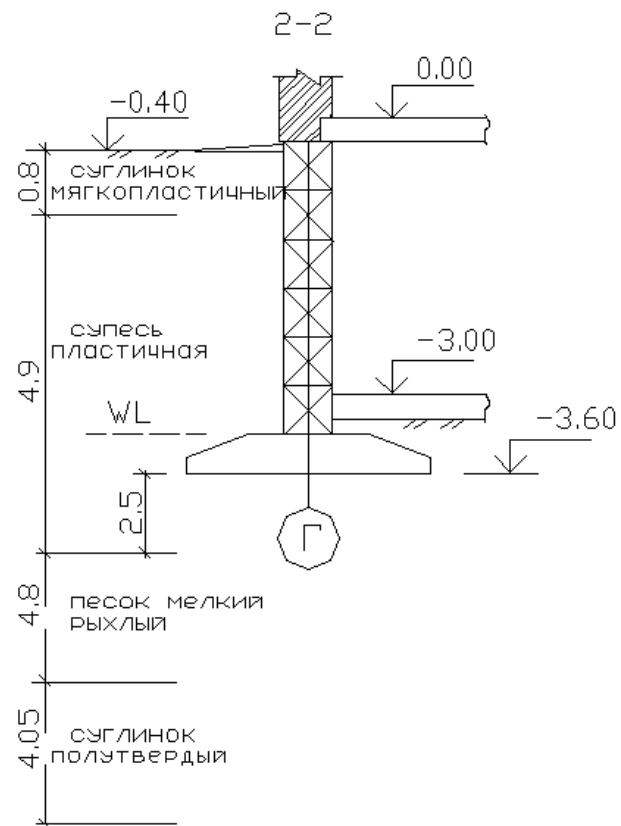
Сечение сборного ленточного фундамента под наружную стену.
